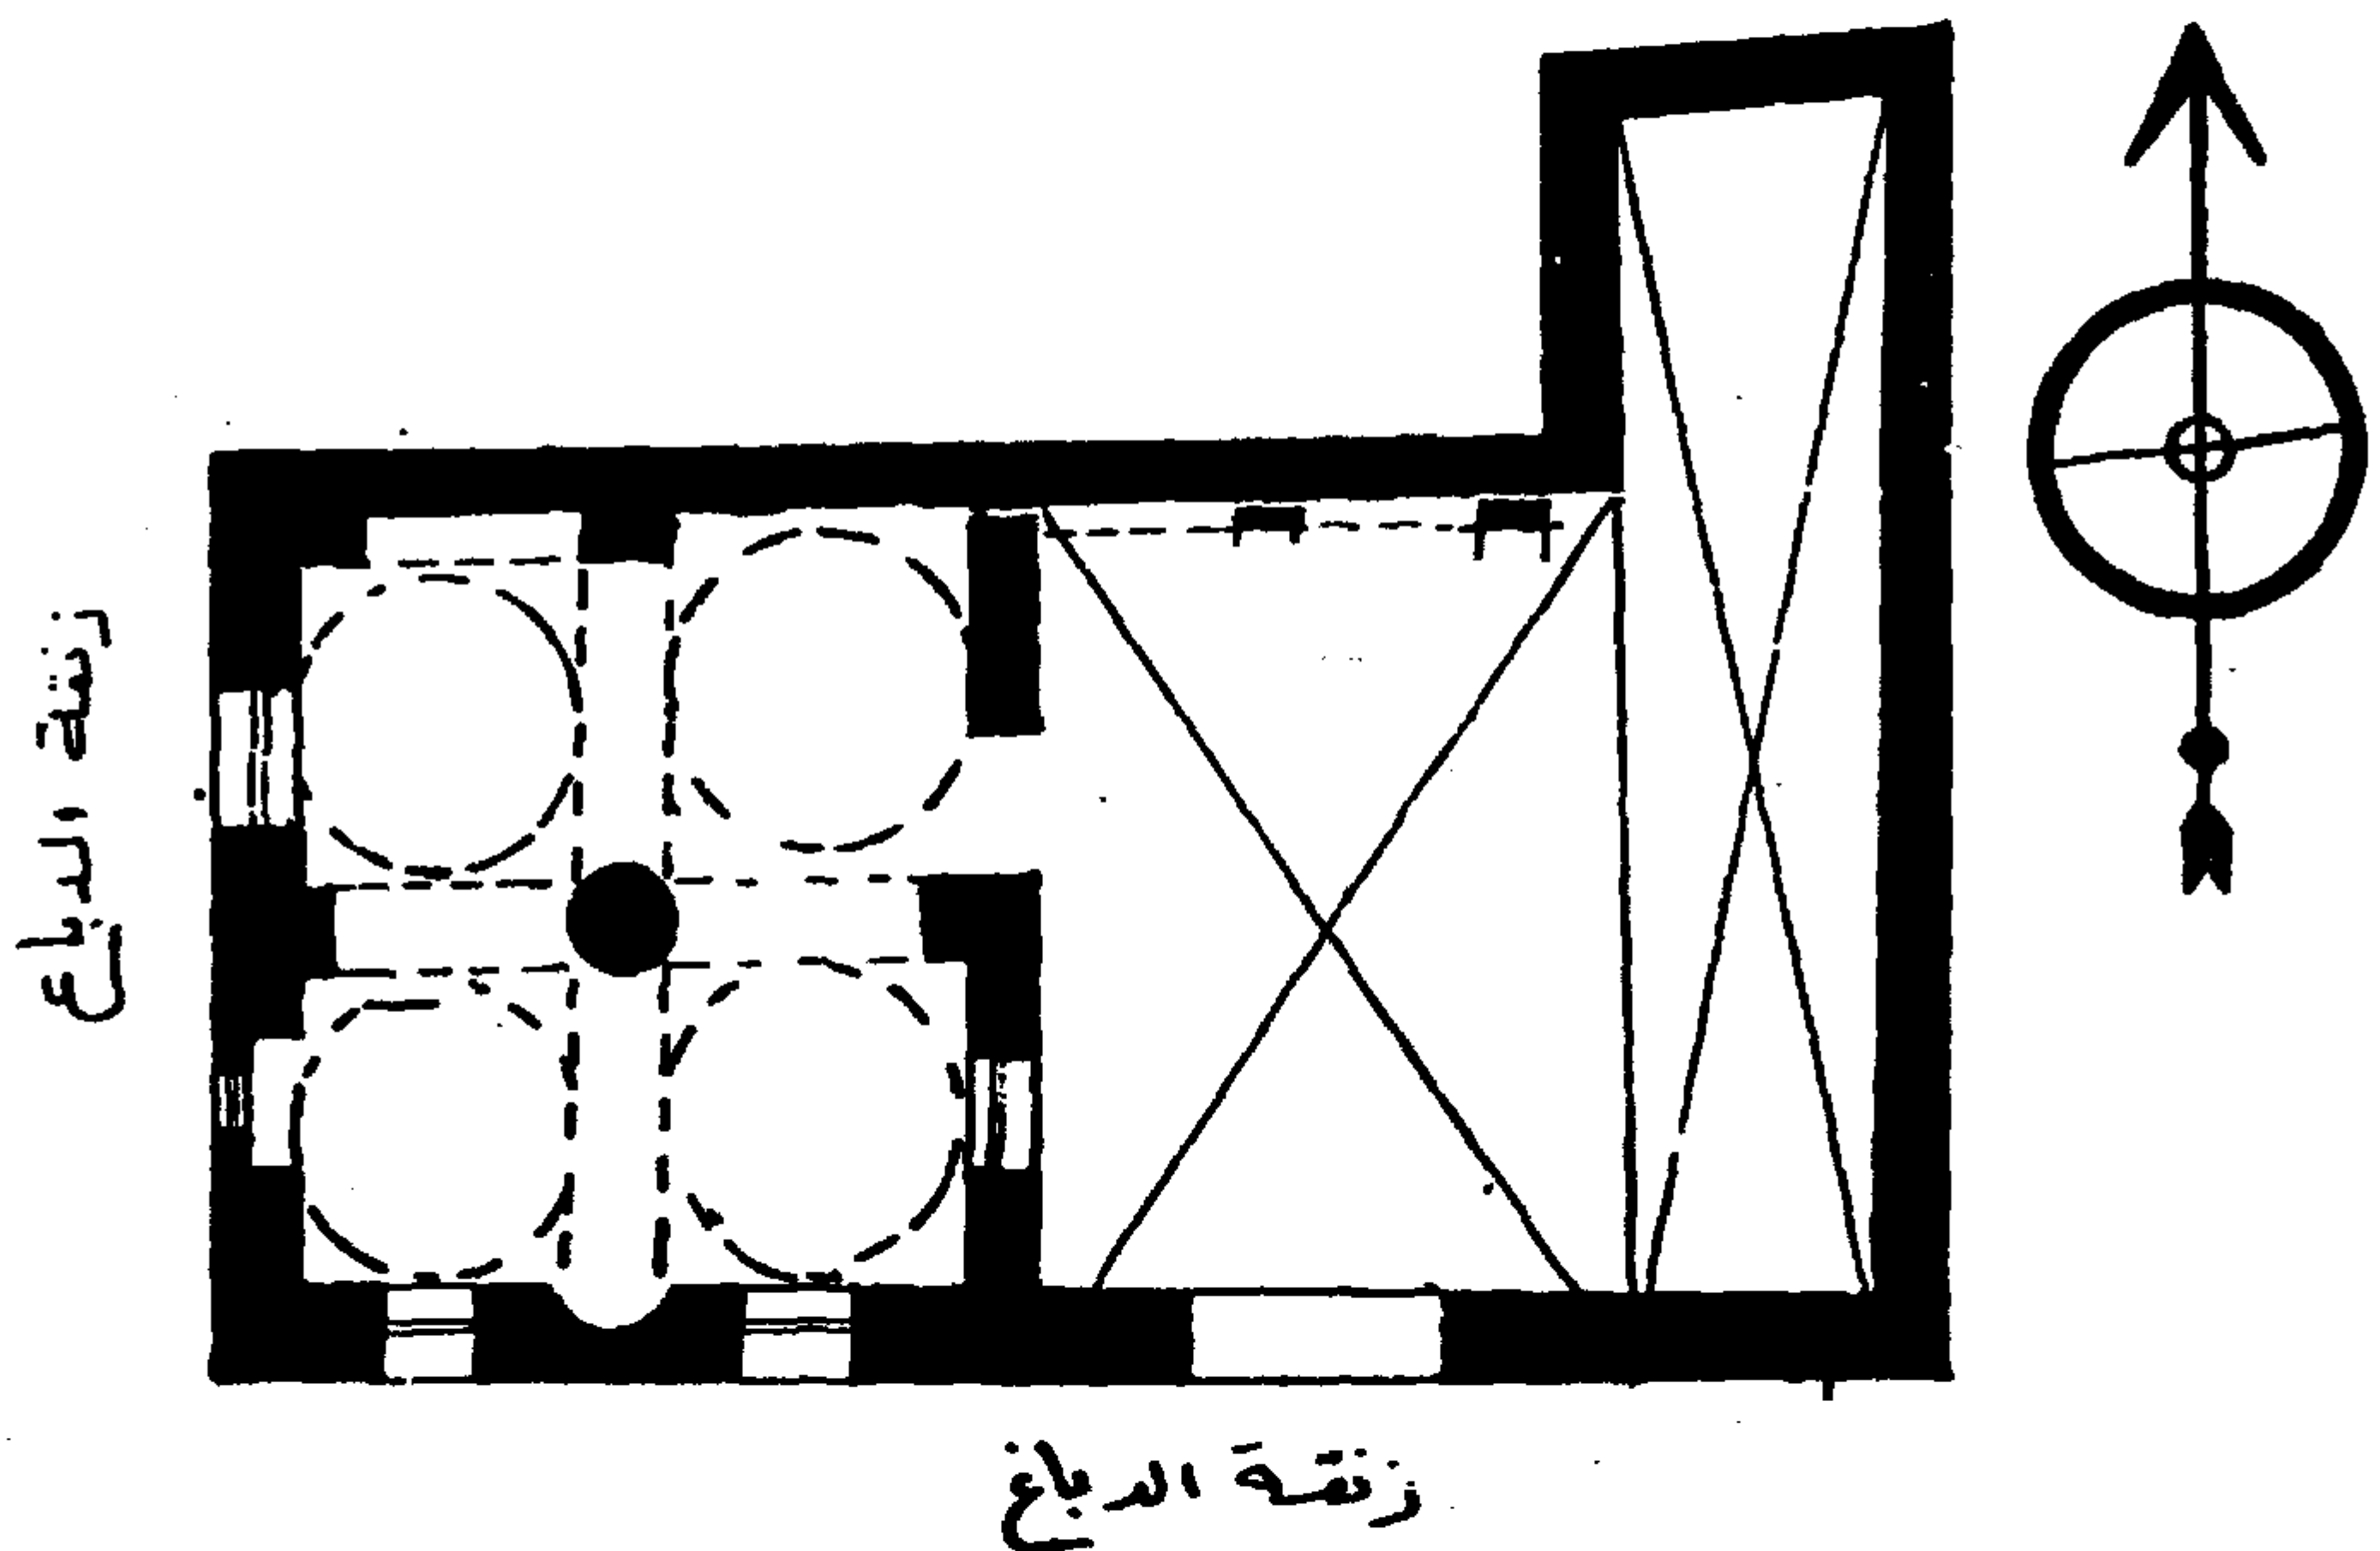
مسقط أفقي لمسجد ابن صوان عن موسوعة الآثار الإسلامية.
